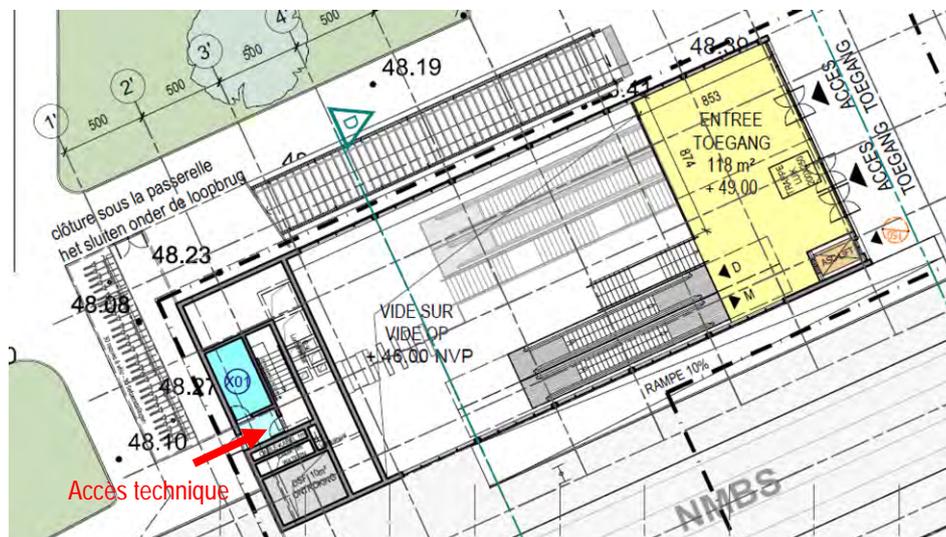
Plan du niveau de surface du pavillon "Petit Bordet" (BMN, 2018)
